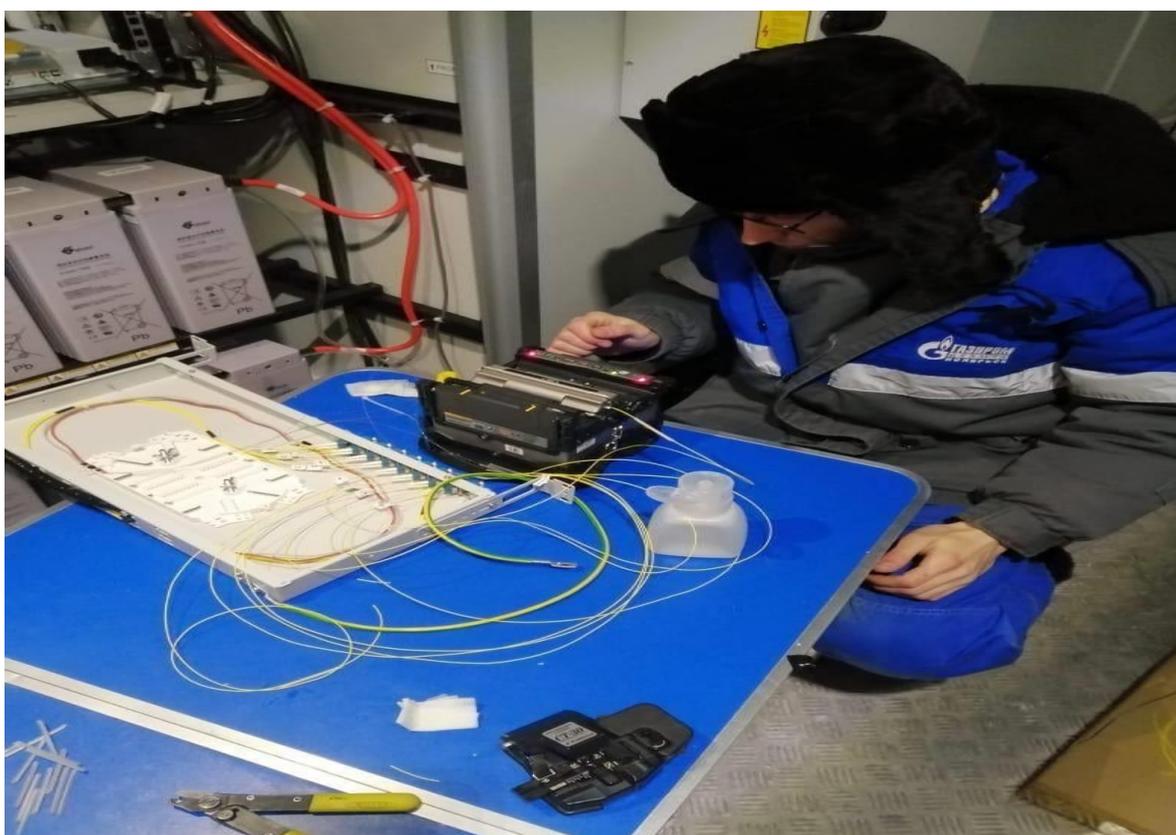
Сварка волокон сварочным аппаратом
